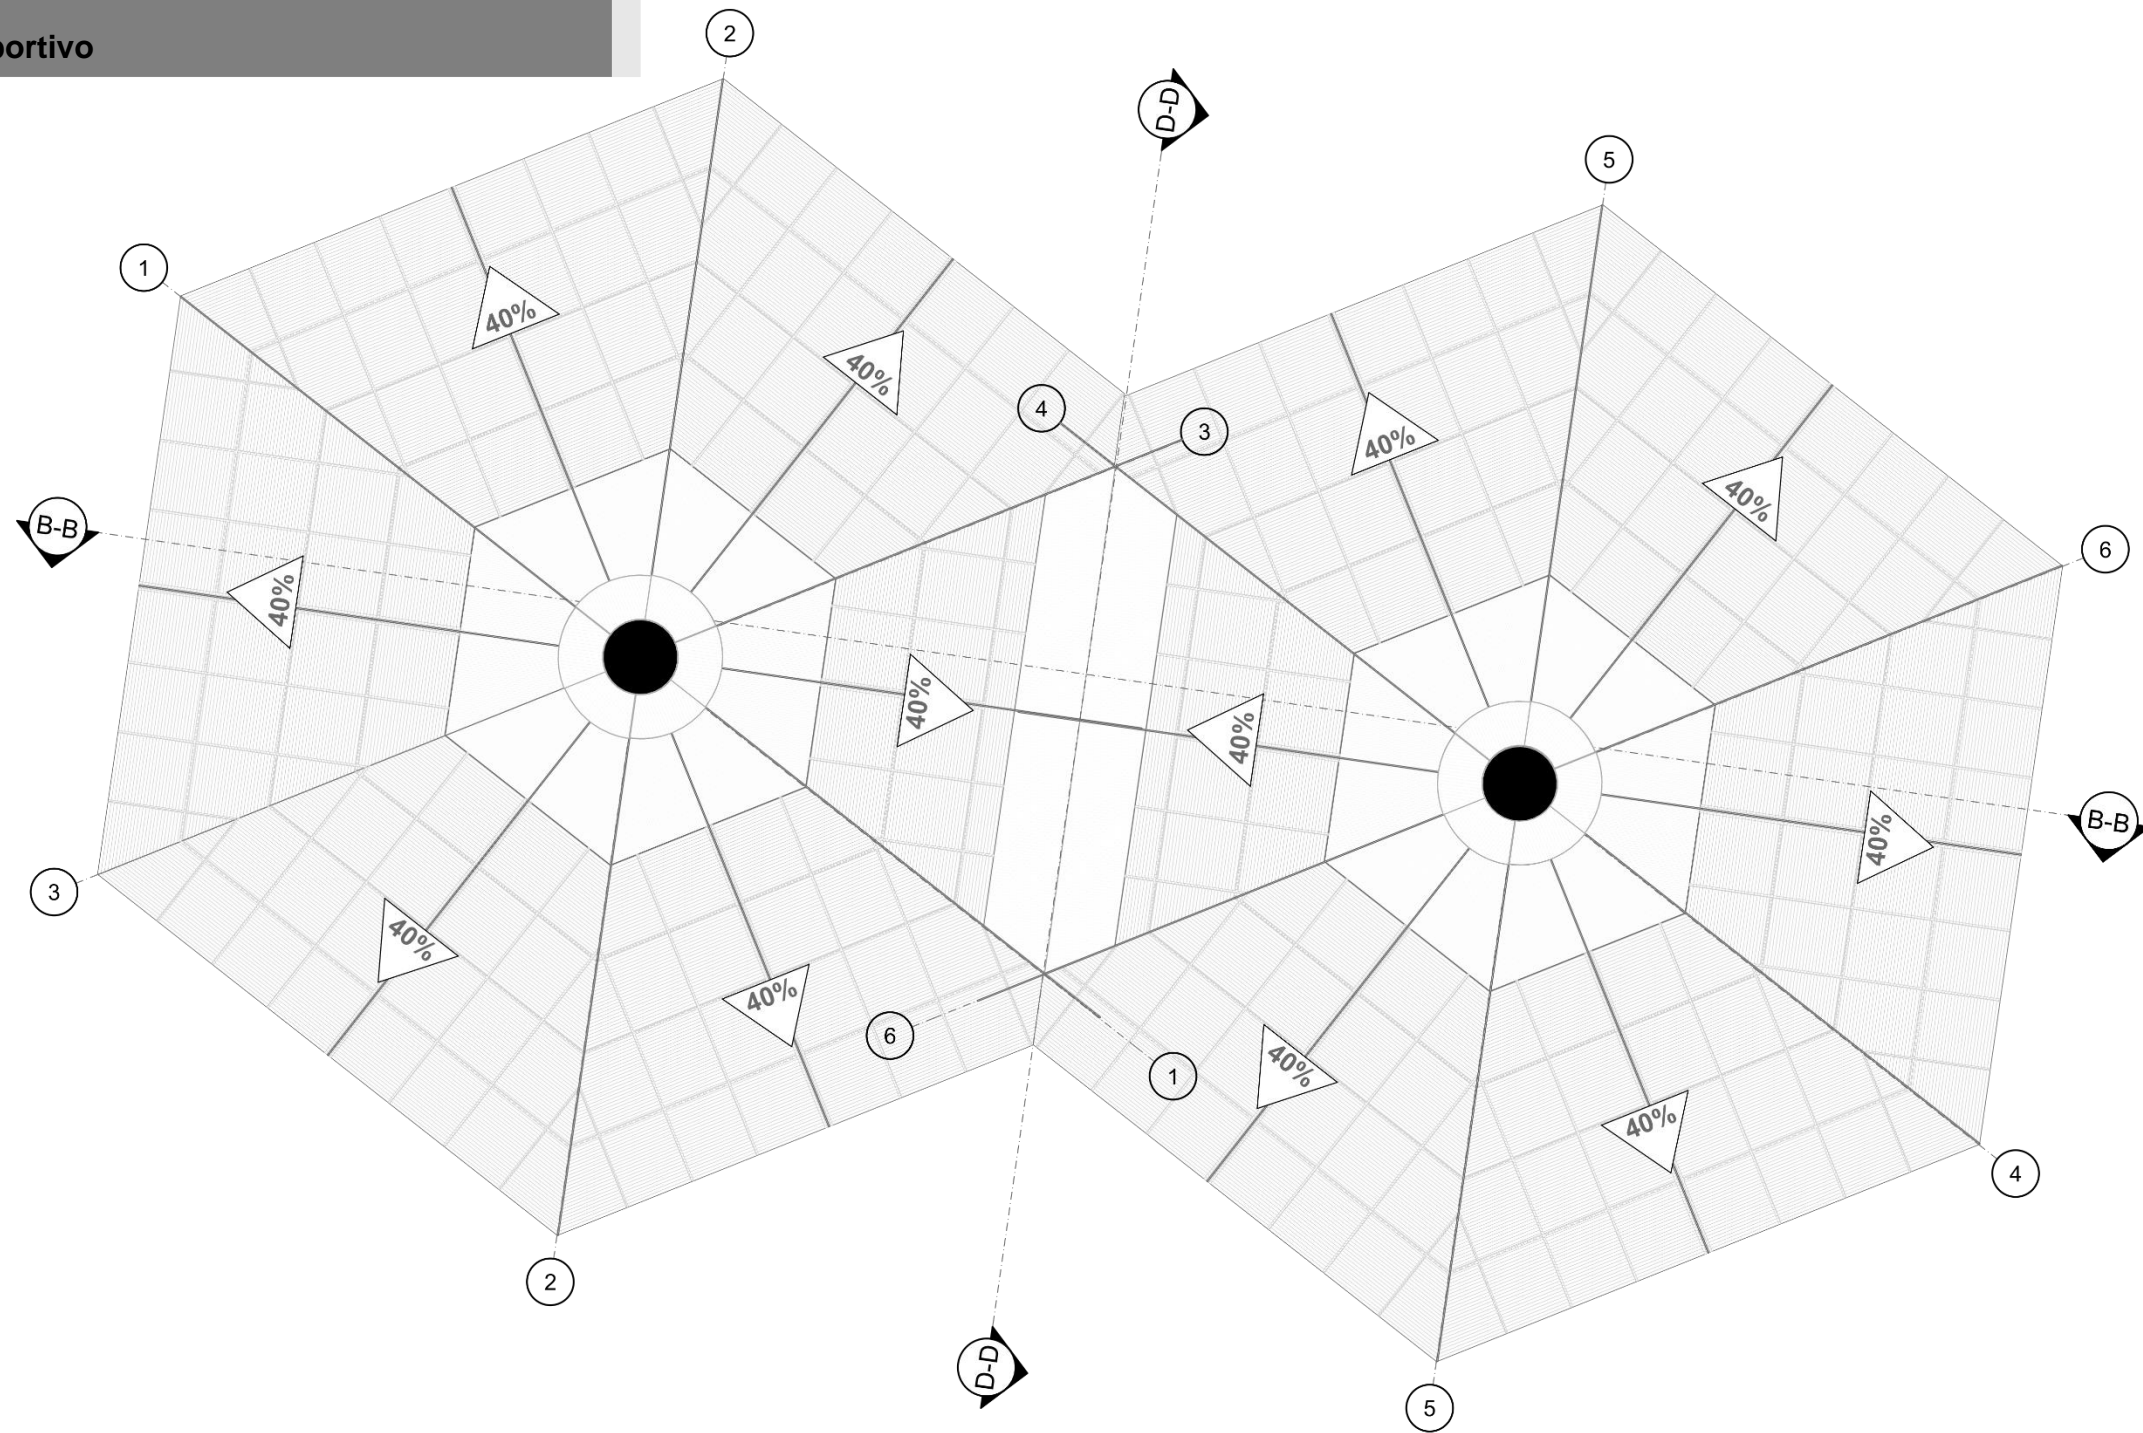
, Planta Arquitectónica de Cubierta Edificio Deportivo, Propiedad Personal, Tomado 2023
